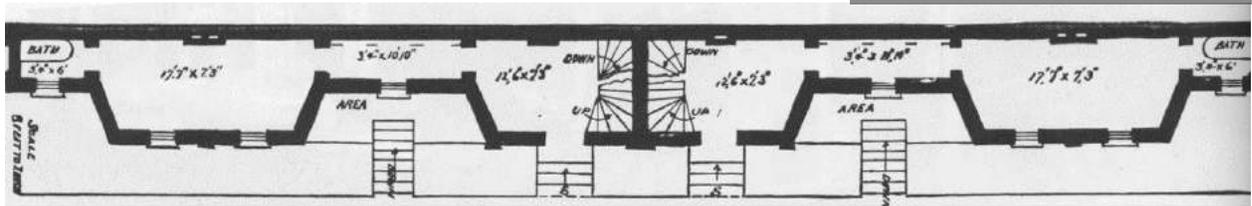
Planta Arquitectónica SPITE HOUSE – Richardson, 1882
